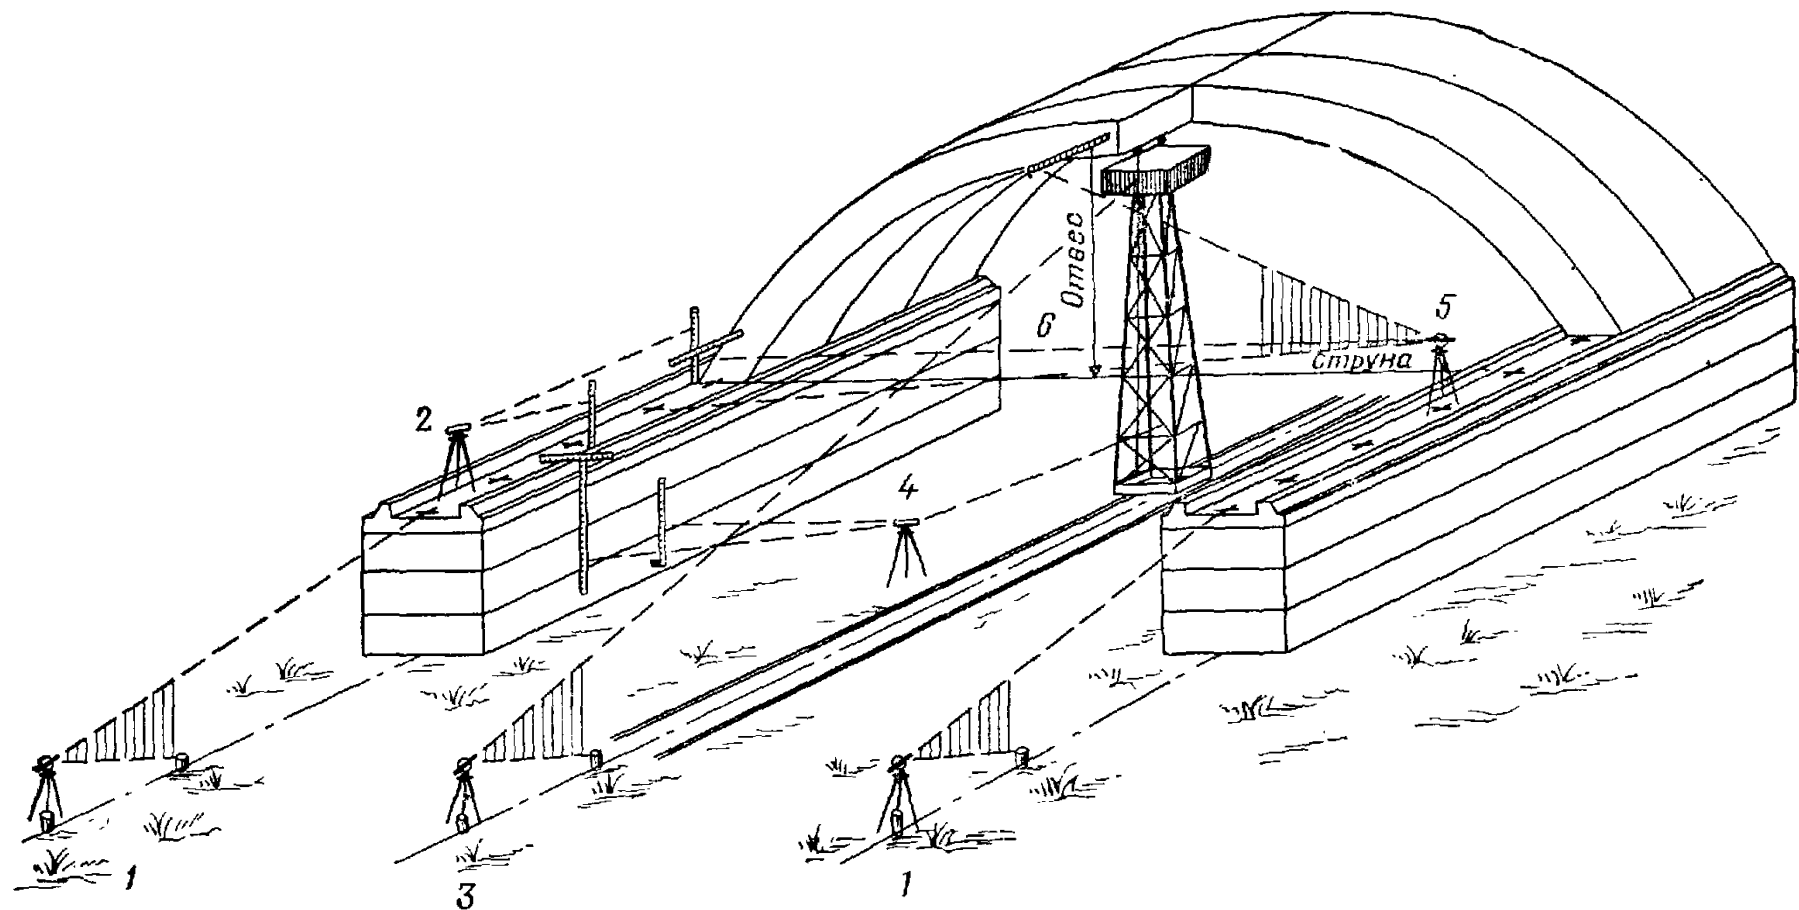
Детальная разбивка и выверка арочного покрытия:
